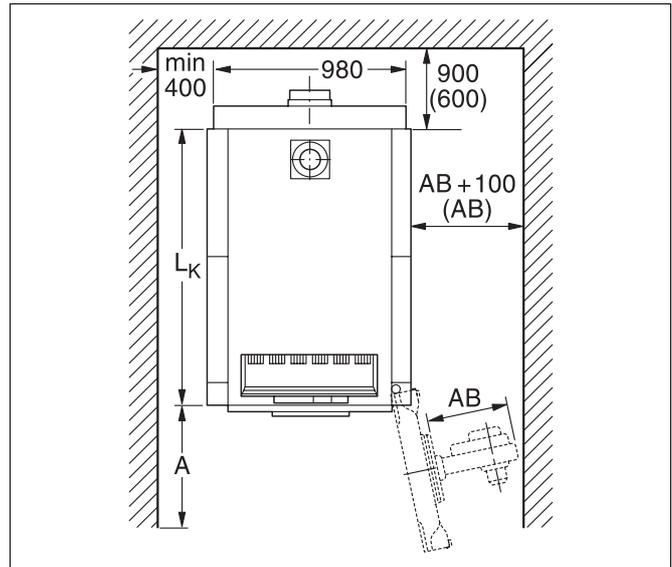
Aufstellraum mit Heizkessel (Maße in mm)
